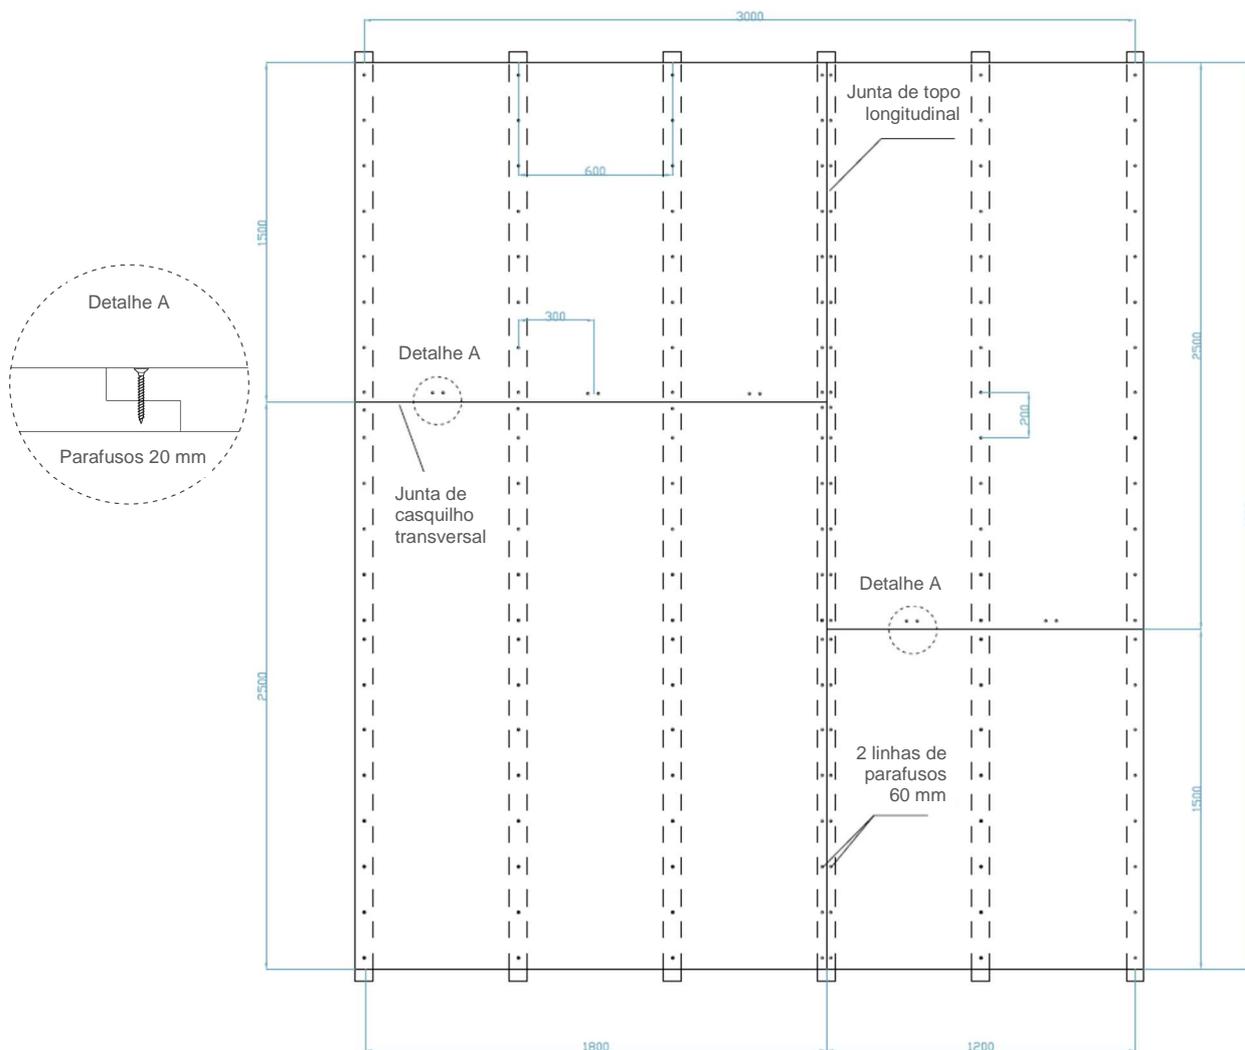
Distribuição das vigas de madeira, juntas de tábuas e fixações mecânicas.
